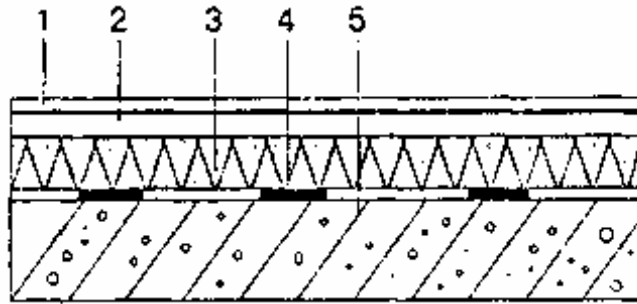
Утеплення міжповерхового залізобетонного перекриття:
